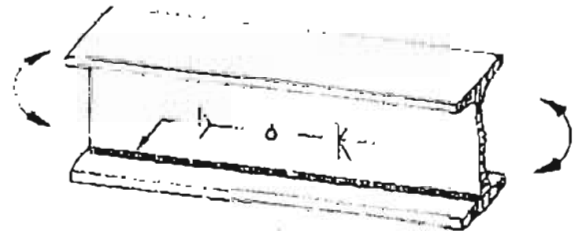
Miembros tipo por revisión de estructura por fatiga.
